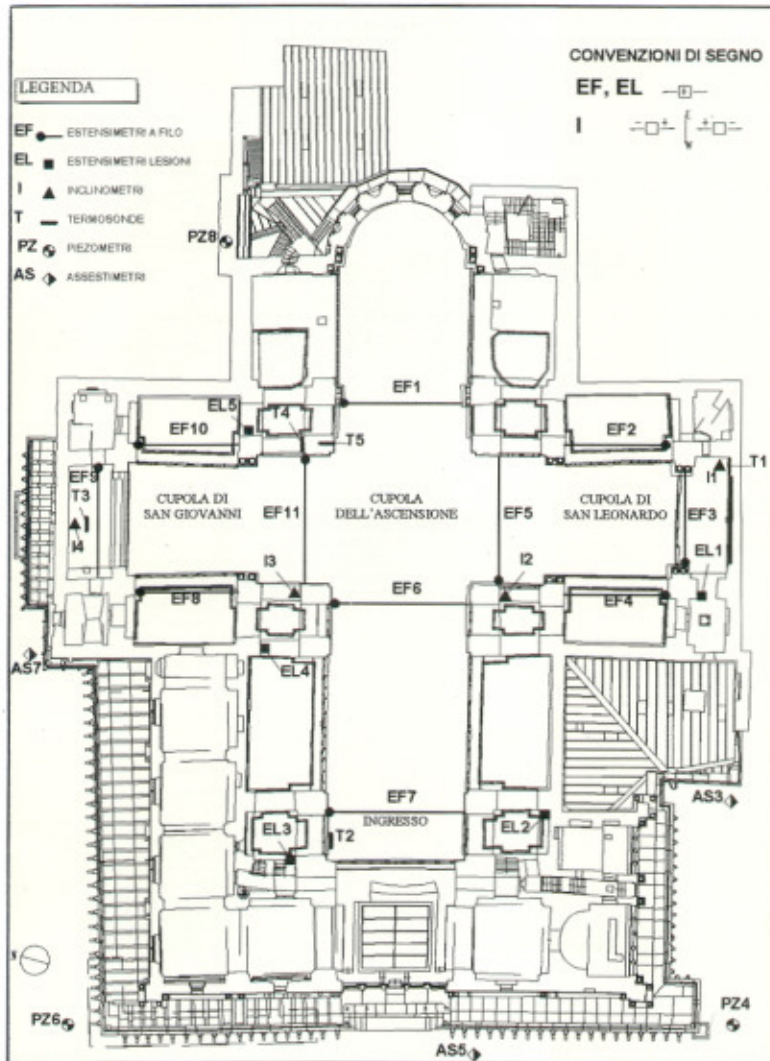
Planimetria della Basilica di San Marco con indicata l'ubicazione degli strumenti
